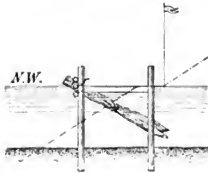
u. 162. Anwendung der WOLfschen Bauweise.
